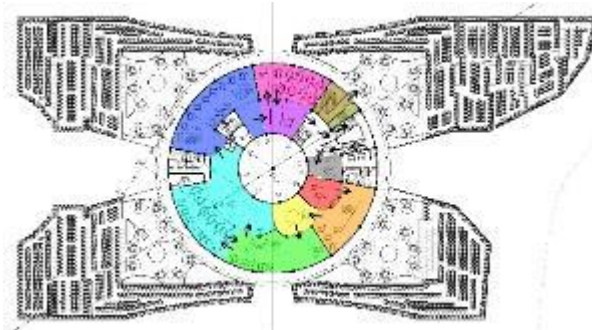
Denah Layout Plan dan sirkulasi pengunjung.
